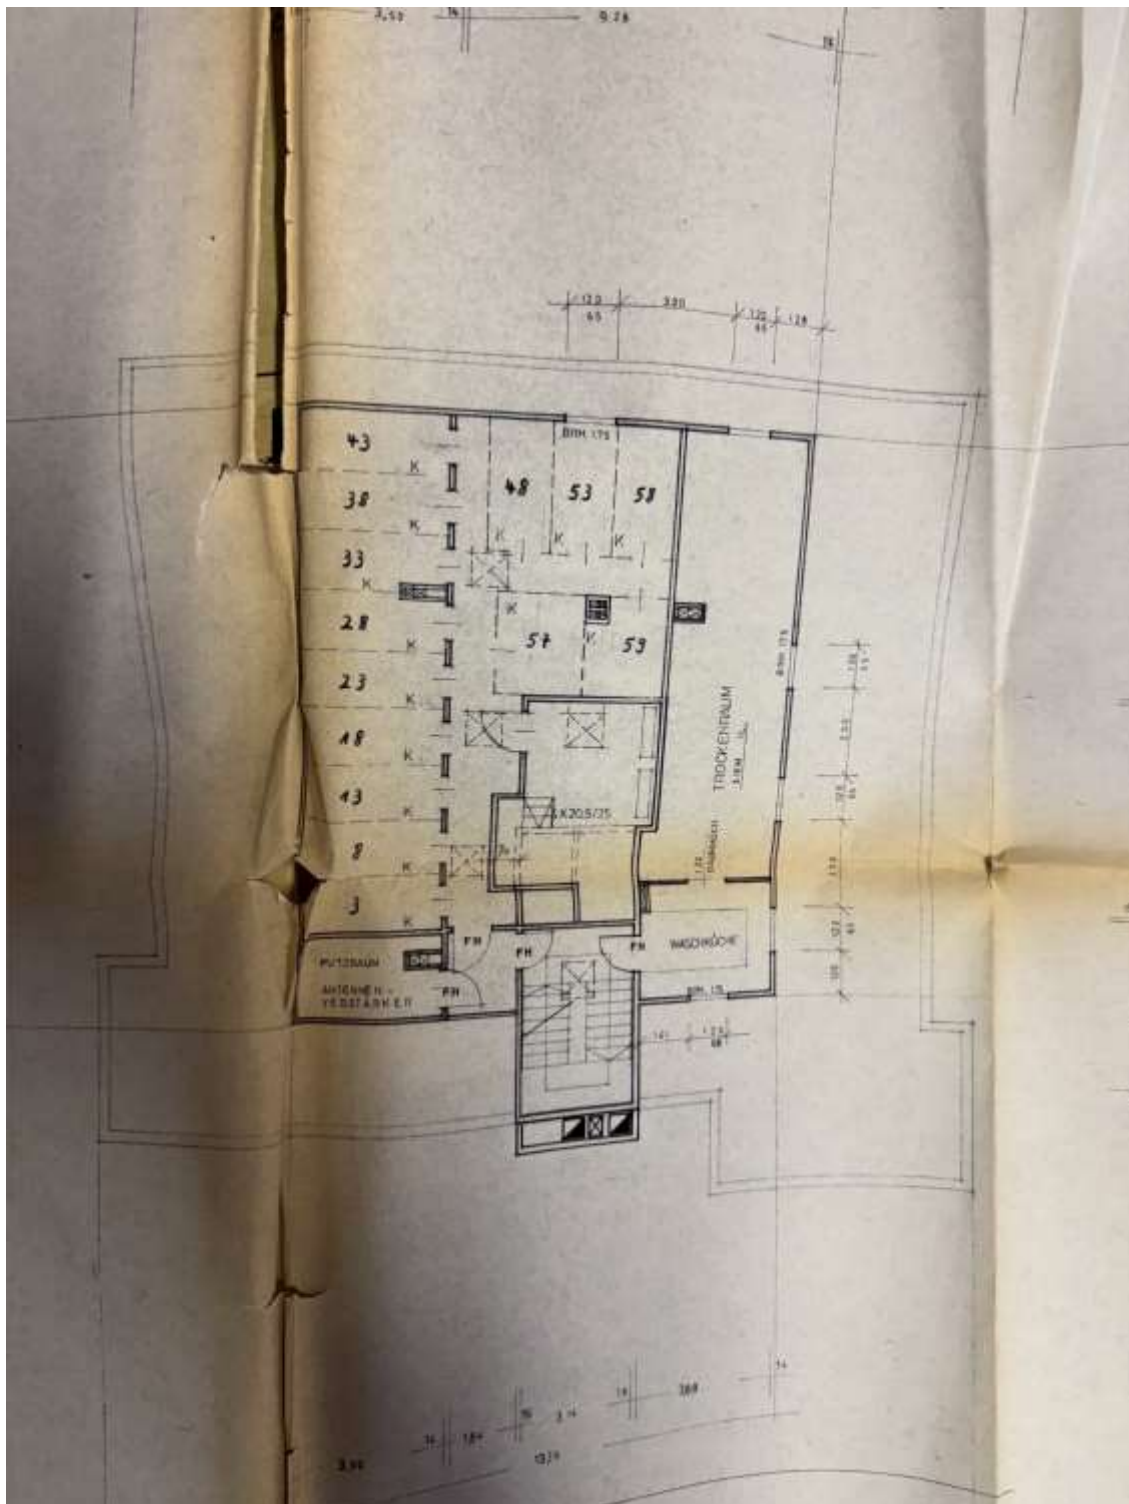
Grundriss SE 13 Quelle: Grundakte (Teilungserklärung)
